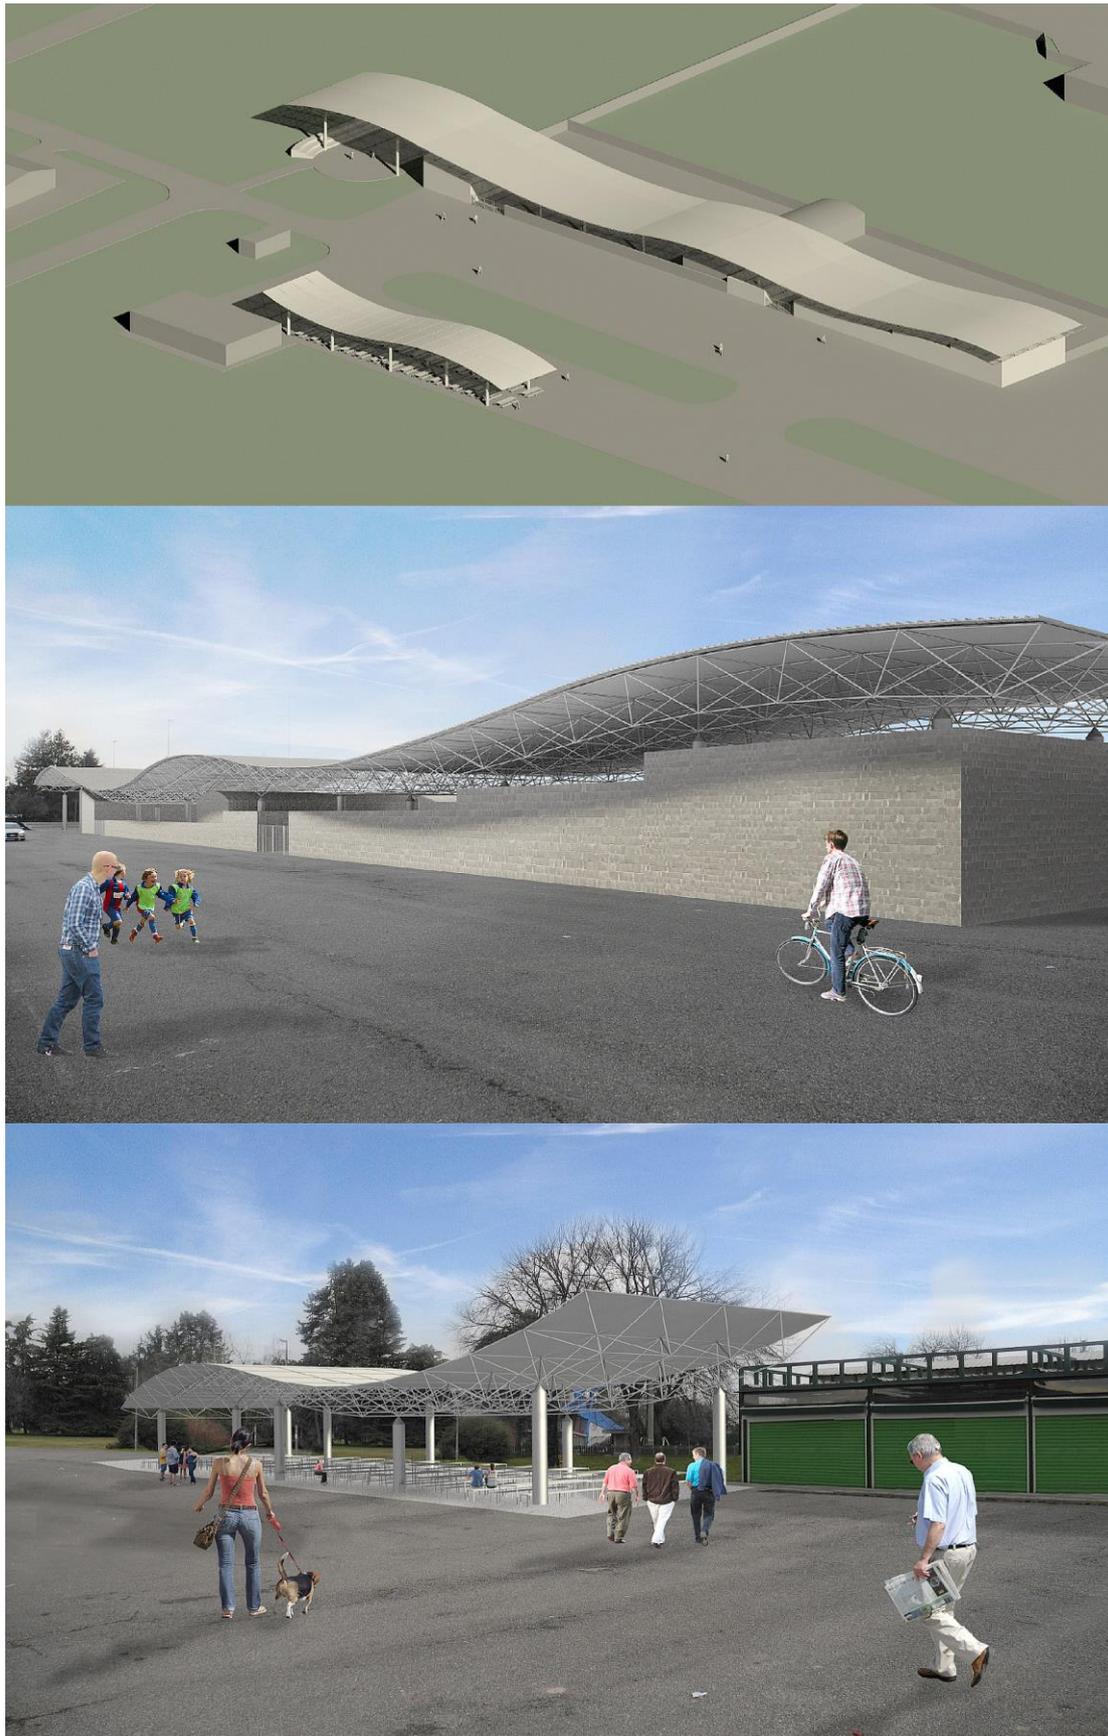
Rendering delle strutture in progetto (Fonte Relazione Tecnica Arch. Andrea Savio)
